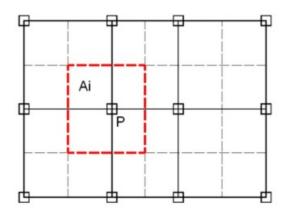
Área de influência i das lajes adjacentes em um pilar P.
